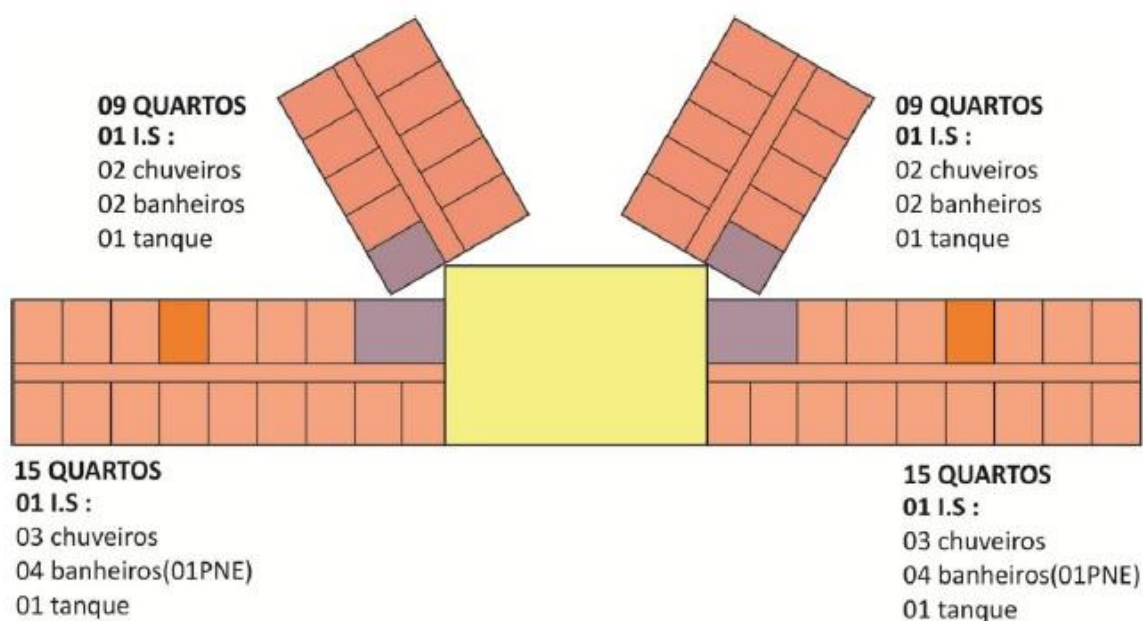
Planta tipo da CEU. Fonte: (SCUSSEL, 2012)
